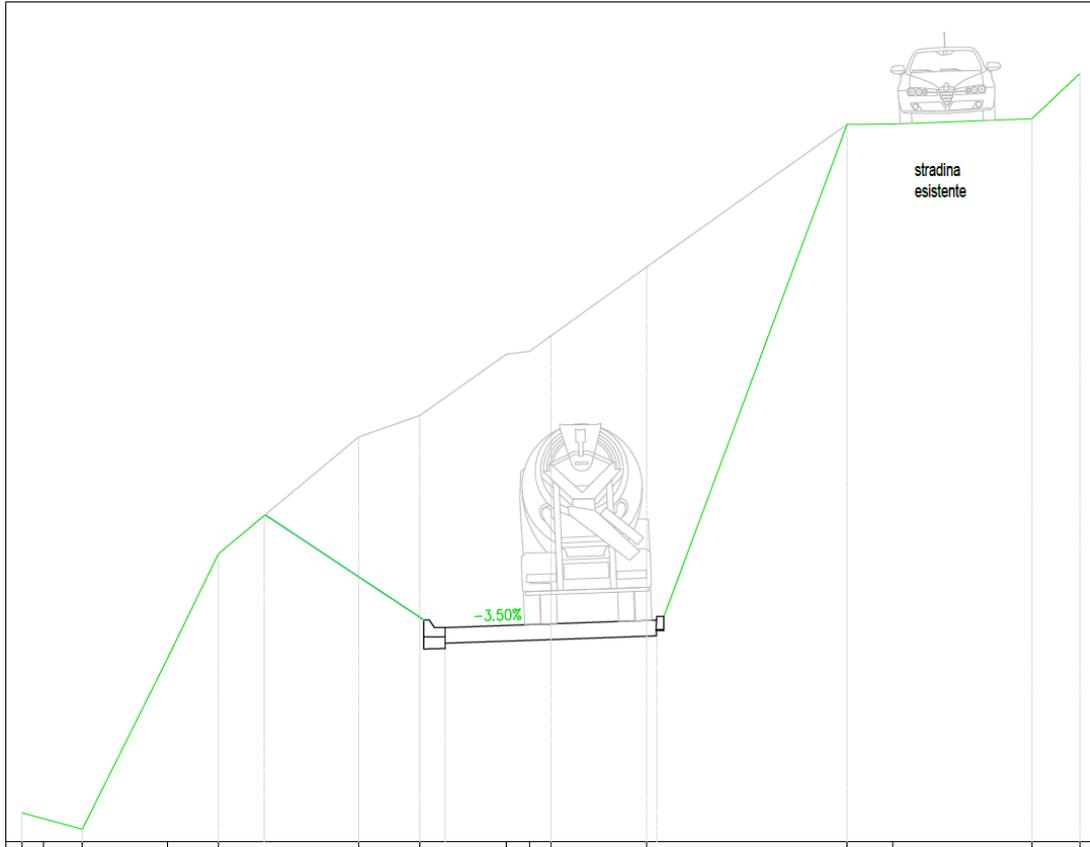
Estratto della sezione tipo del terzo tratto
